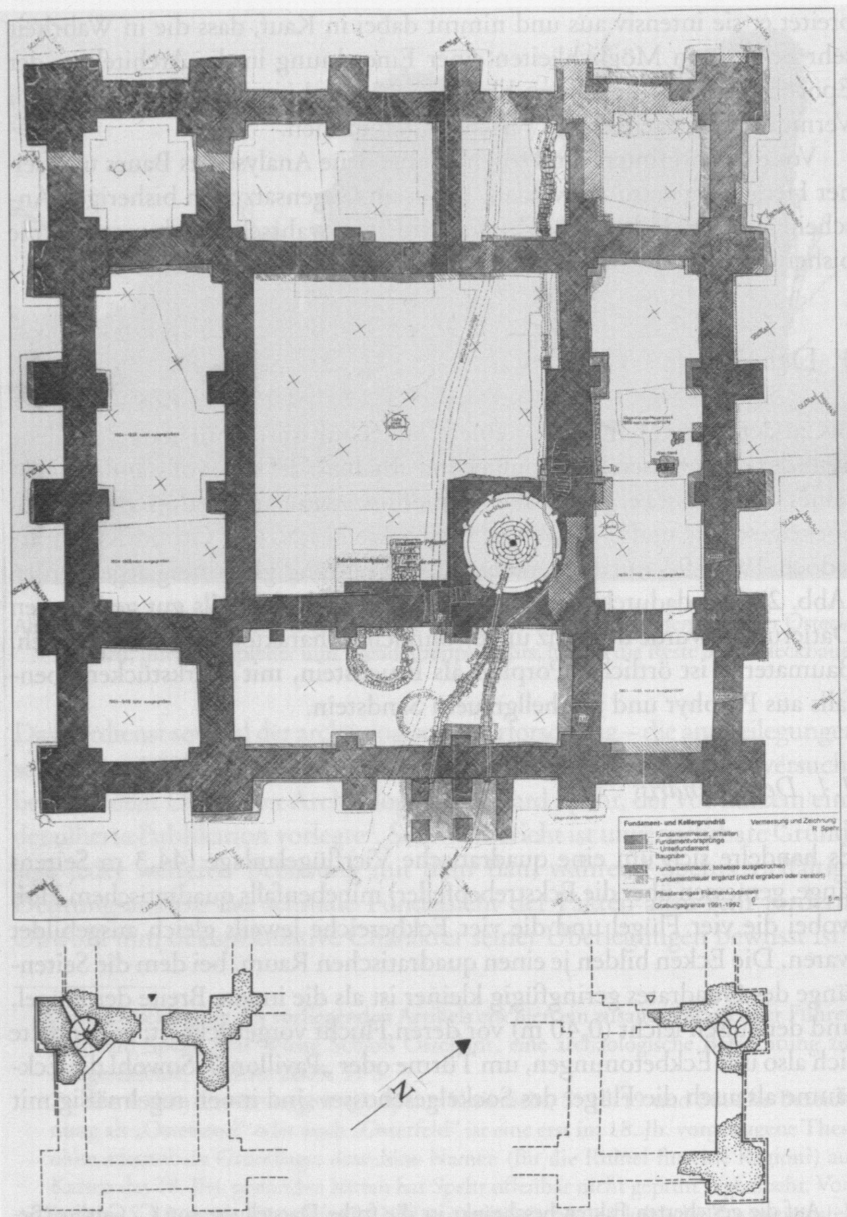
„Wüstes Steynhus“ bei Oschatz, Fundament- und Kellergrundriß nach Spehr, Grundriß der erhaltenen Mauern des Erdgeschosses
